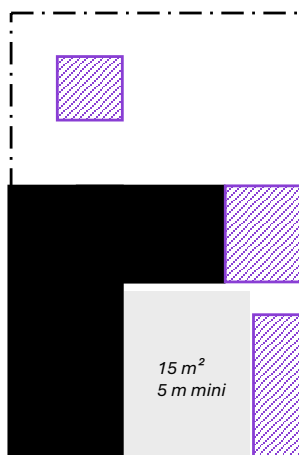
zones d'implantation possibles pour les extensions de la construction existante
